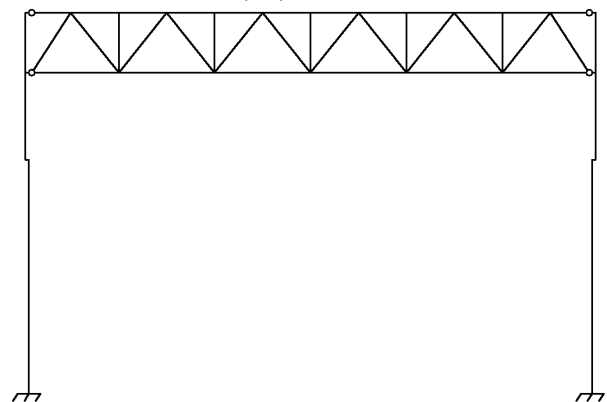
Расчетная схема поперечной рамы с ригелем в виде фермы, жестко сопряженной с колоннами.
